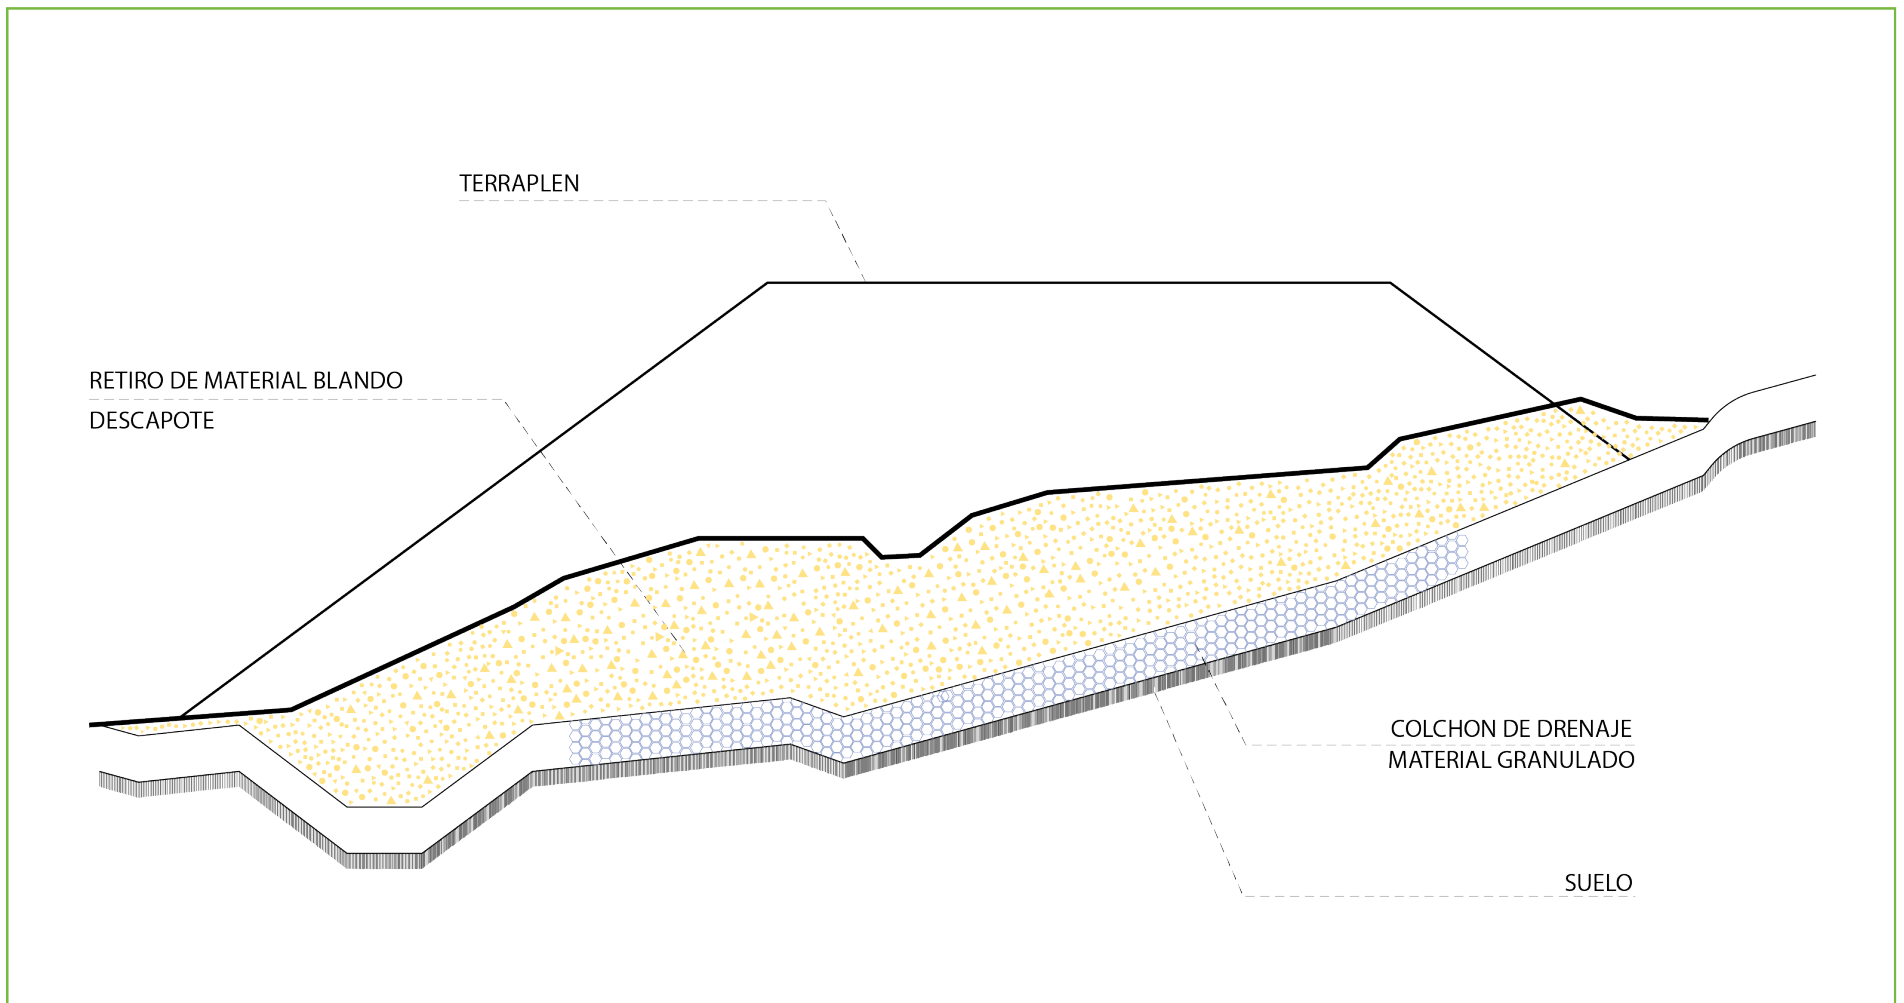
Tipos de zanjas para dren, colchon de drenaje.
